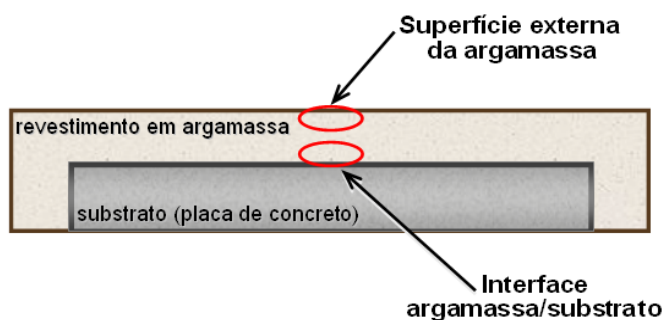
Representação esquemática do corte do corpo-de-prova apresentando os locais de extração das amostras da argamassa para o ensaio de porosimetria por intrusão de mercúrio.
